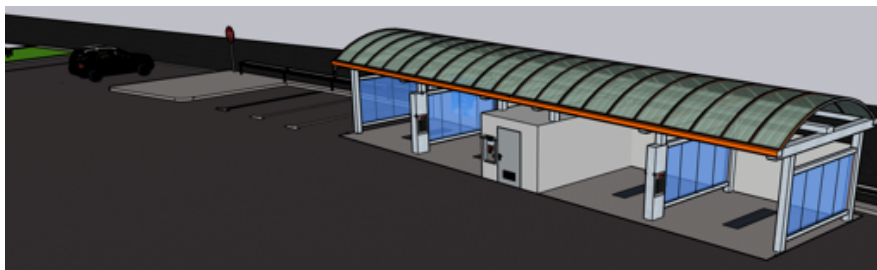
Implantación de cabinas de lavado. Elaboración propia con SketchUp.
